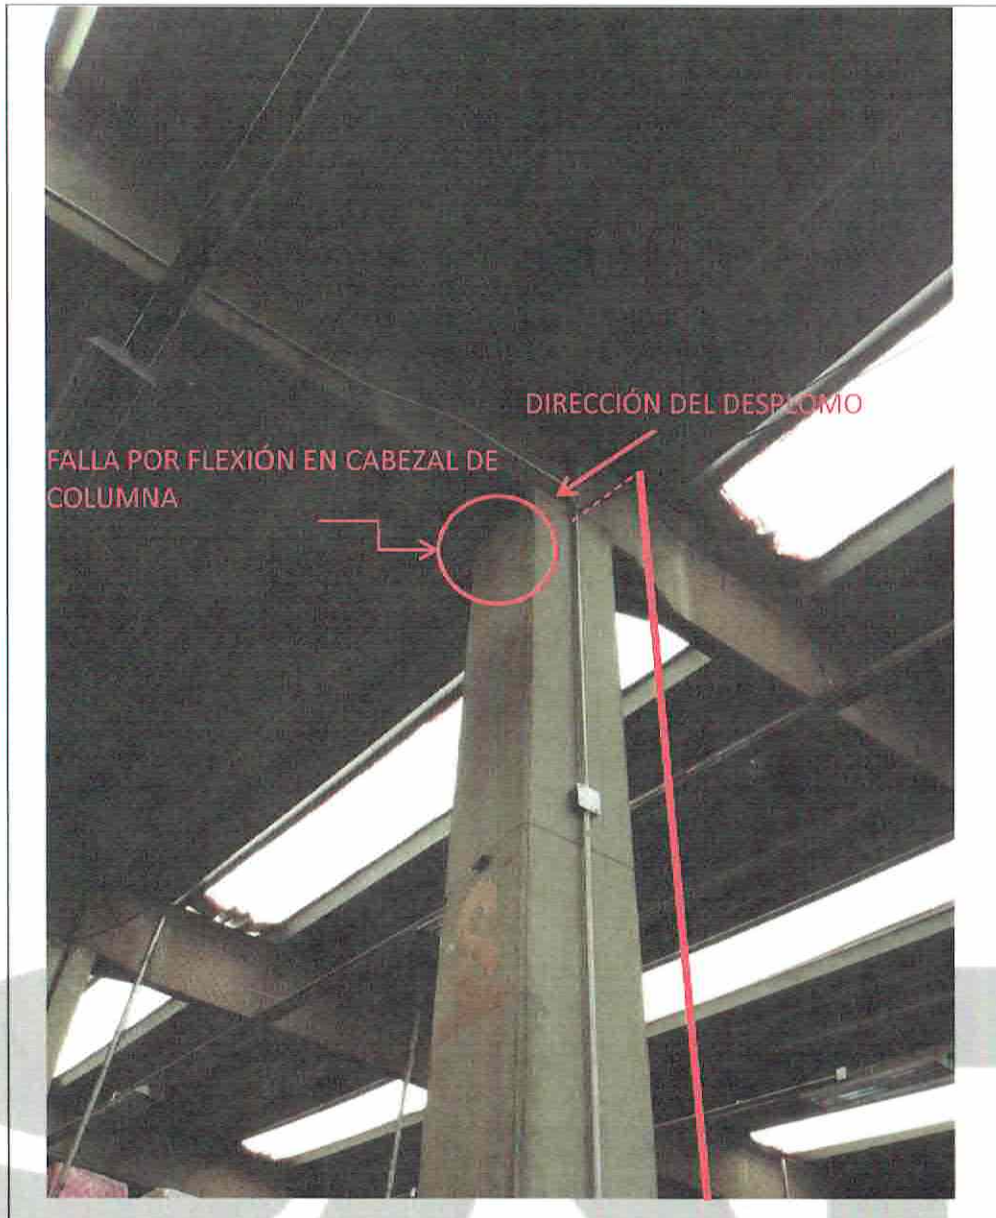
Columna fallada y desplomada en bodegas de IBERIA. Se recomienda su reforzamiento inmediato para posteriormente reemplazarla.
